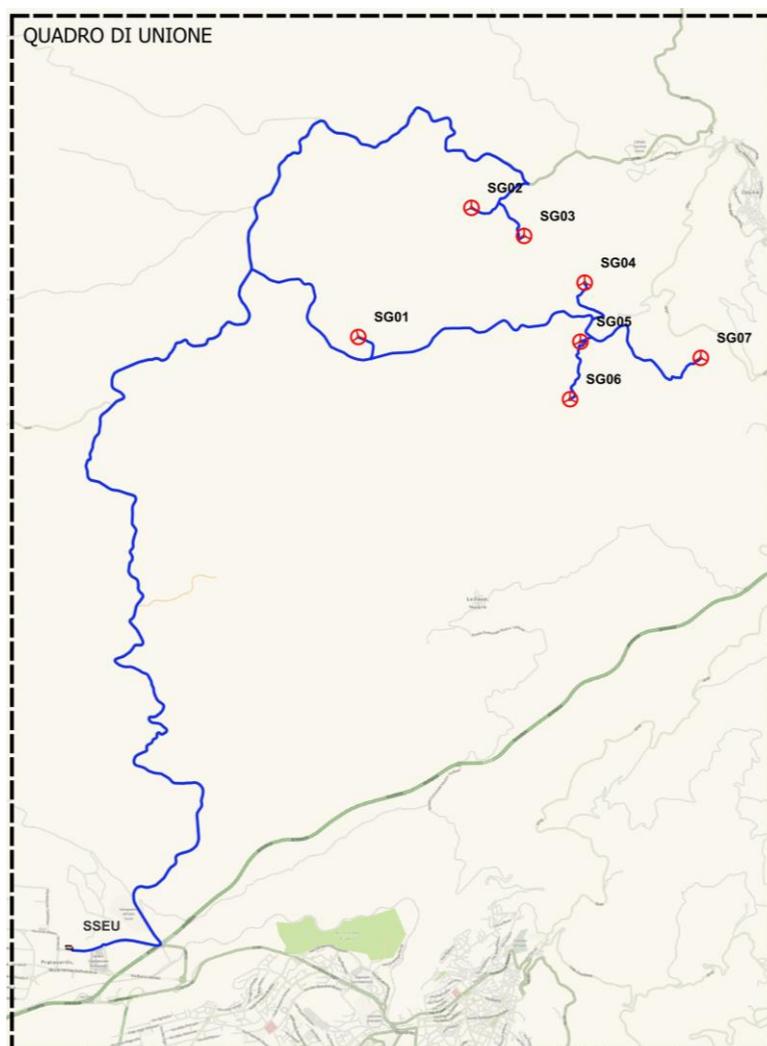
layout progettuale dell'impianto eolico CE Nuoro Nord
